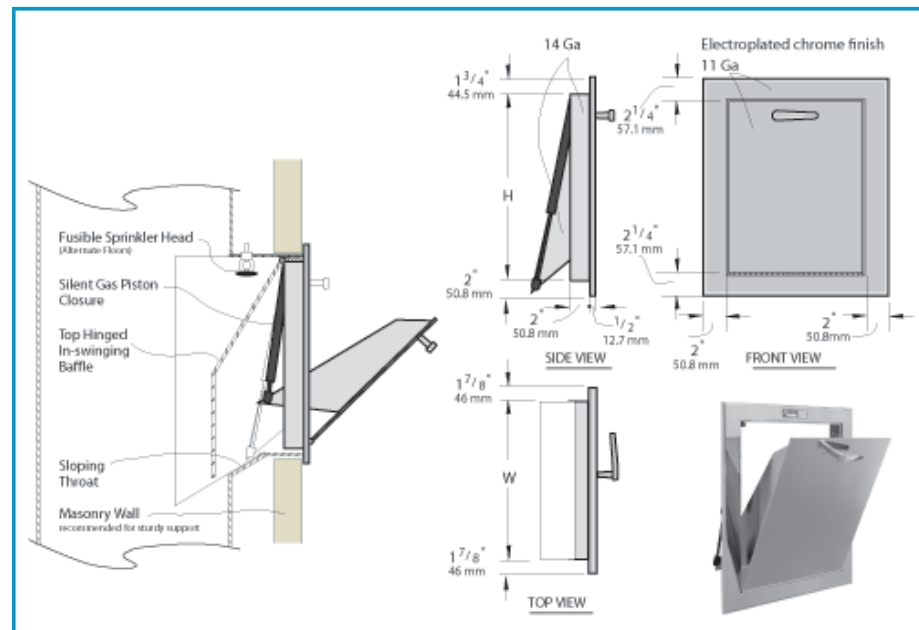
ROCIADOR AUTOMÁTICO O SPRINKLER
